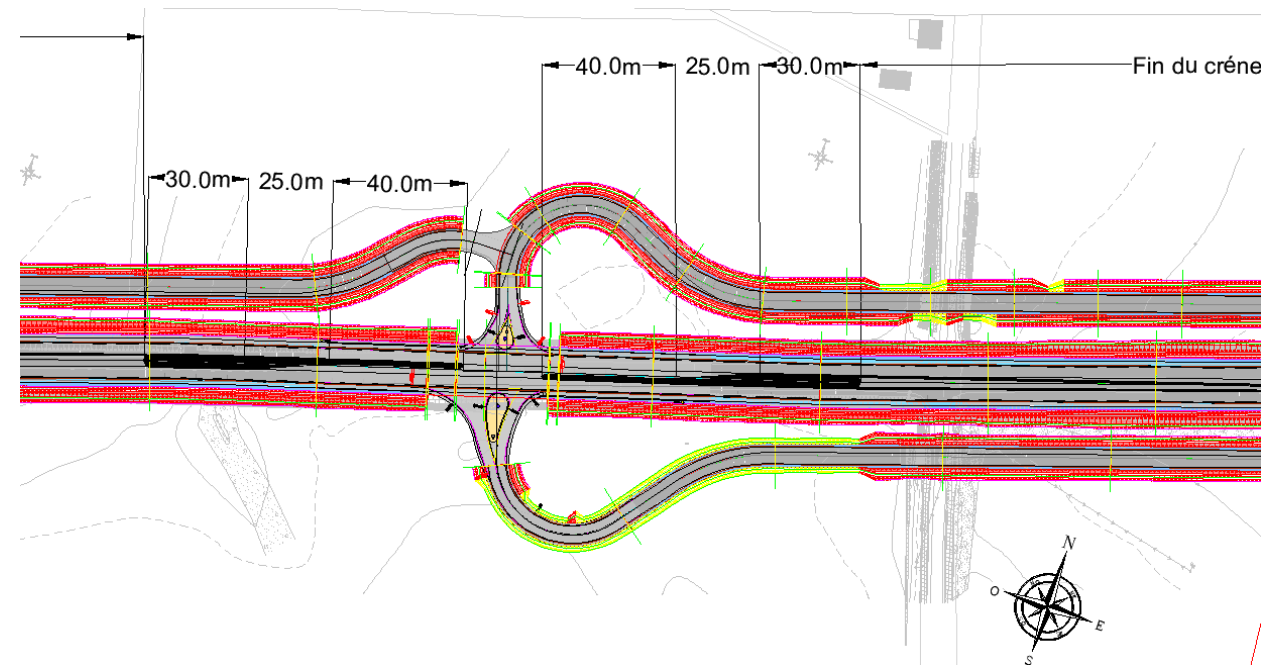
Plan du carrefour de Saint Eugène - Section 2
